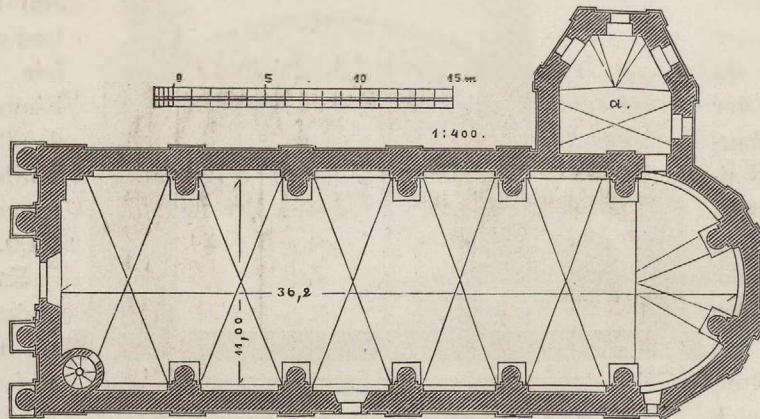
Schrotz. Grundriss der kathol. Kirche.
